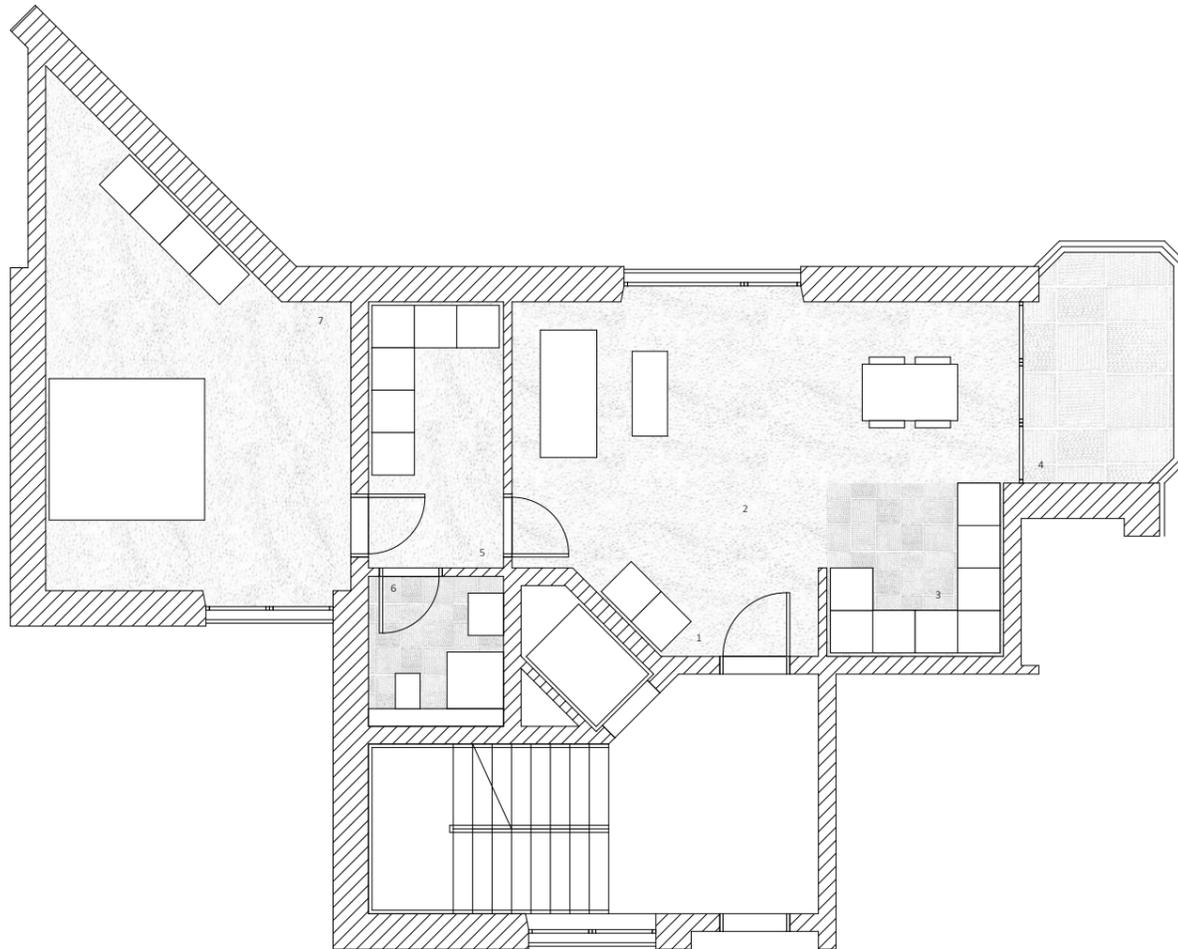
Grundriss Wohnung 13/Stiege 2
